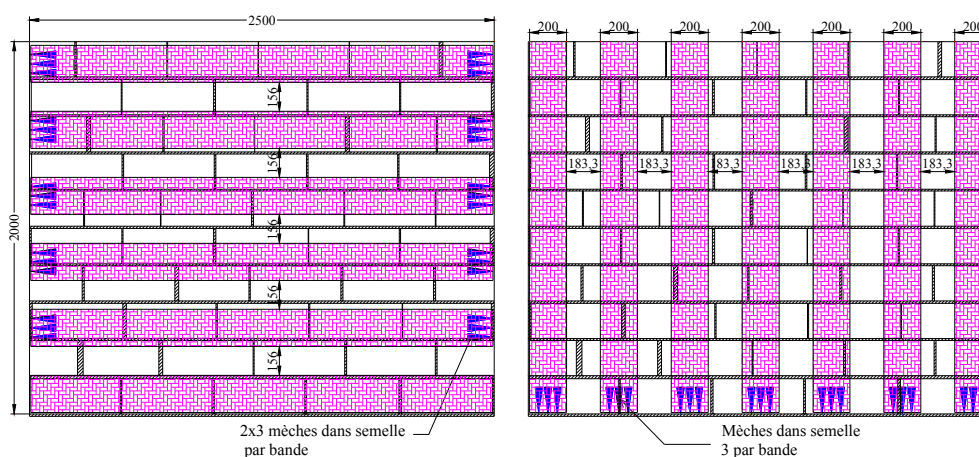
Renforcement horizontal et vertical du mur n°3
